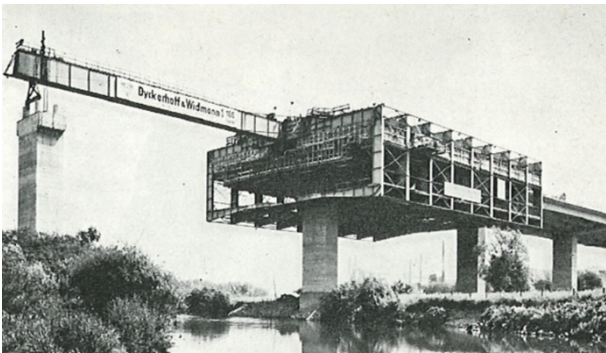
Herstellung mit Vorschubrüstung (© Beton-Verlag)
